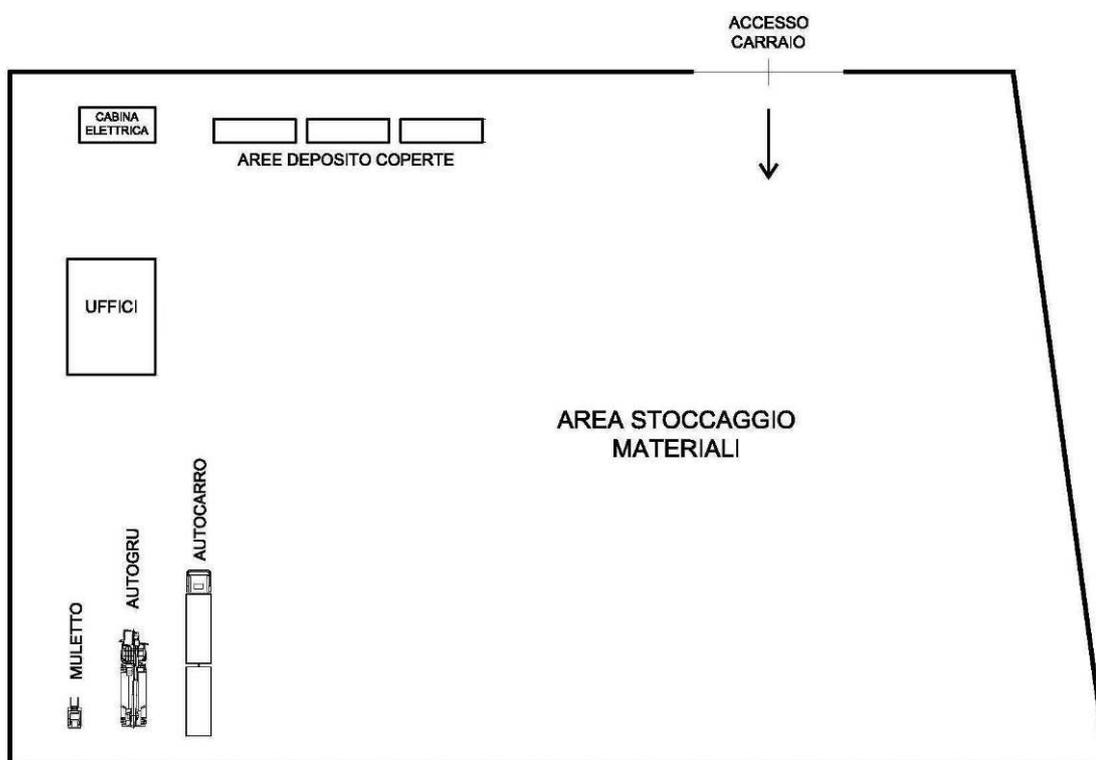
Planimetria dell'area centrale di cantiere - misure indicative
